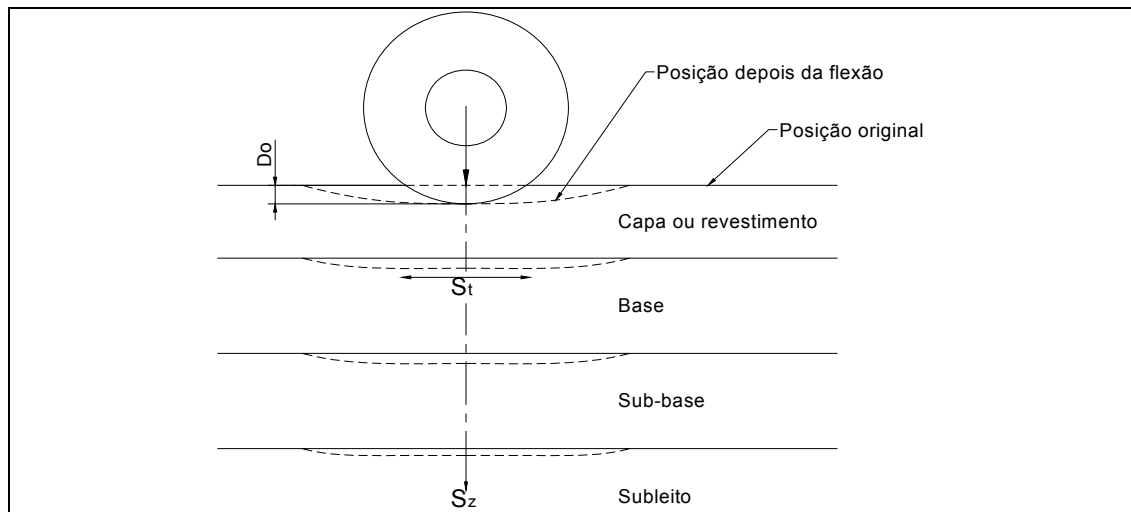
Tensões e deformações no pavimento (Manual de reabilitação de pavimentos asfálticos – DNER 1998)
